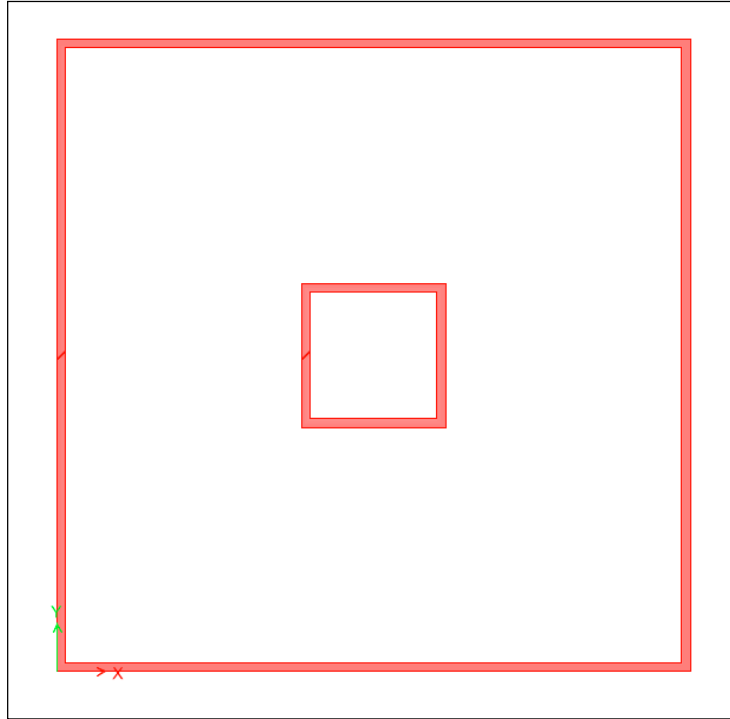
Vista en planta del Edificio B (elementos tipo barra de sección transversal irregular)
